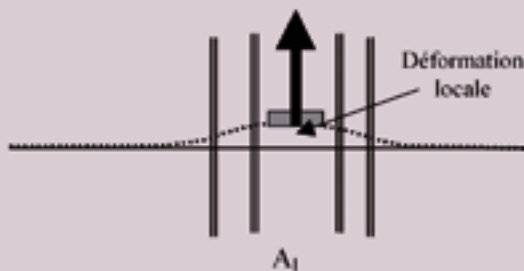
Ancrage en section intermédiaire – armatures longitudinales
